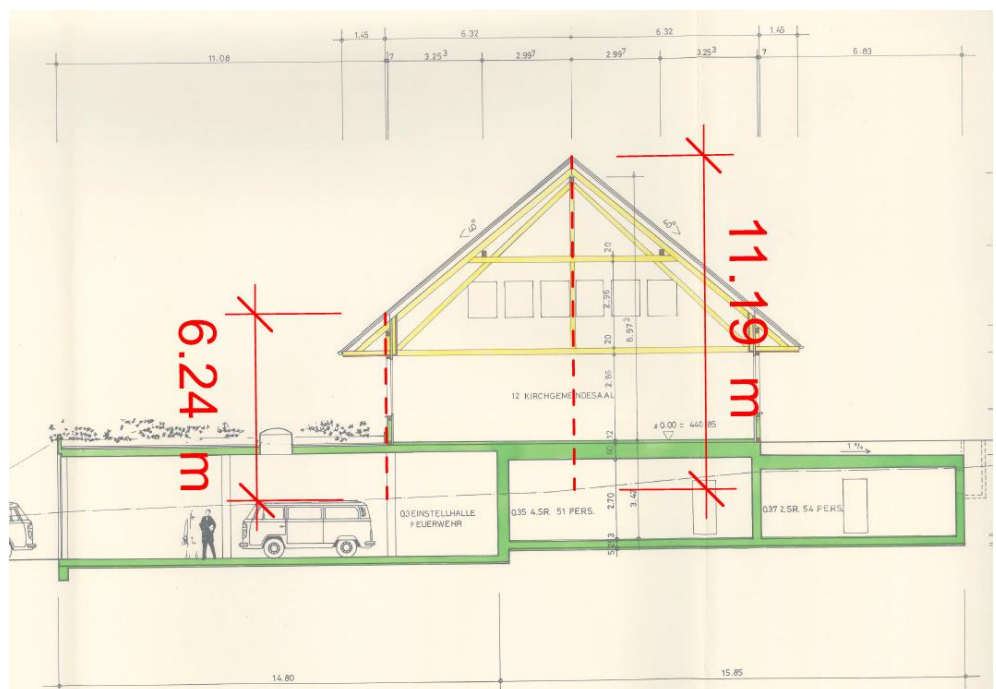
Fassadenhöhen des bestehenden Gemeindezentrums (Quelle: Baupläne Gemeinde Arch)
